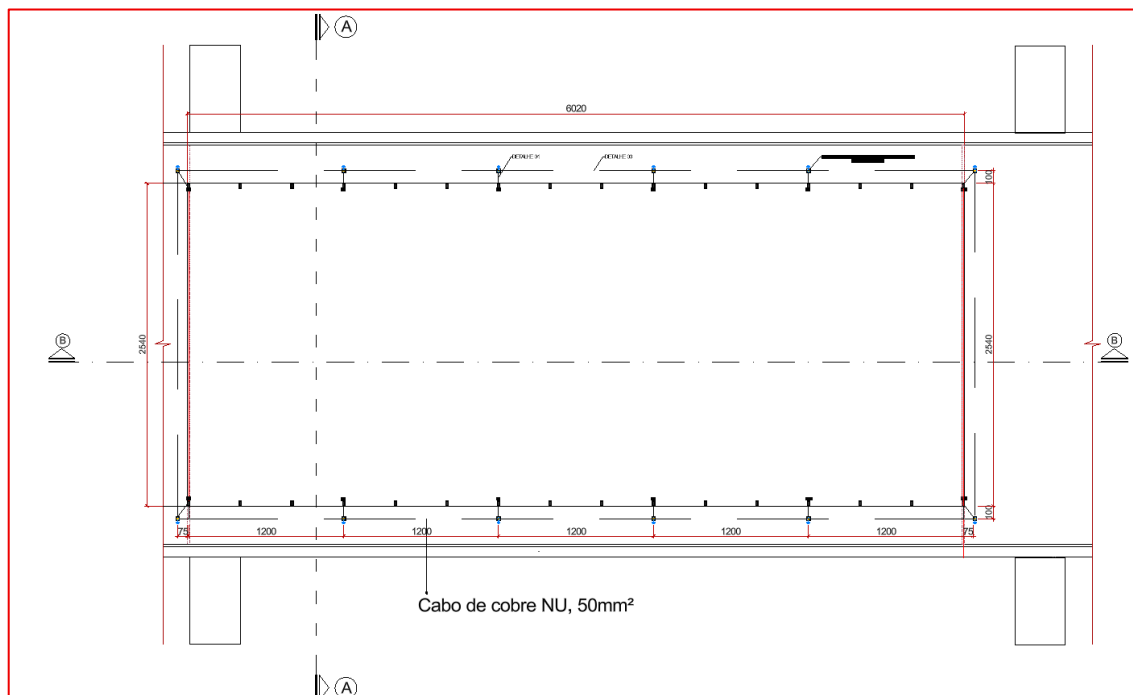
Planta baixa indicando o aterramento do SPDA. Fonte: Projeto.
